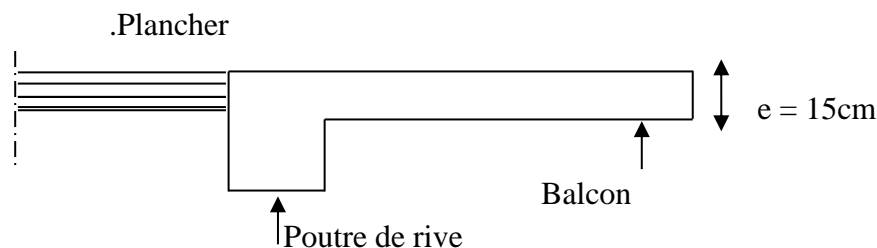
Coupe verticale détaillant la liaison balcon – poutre
